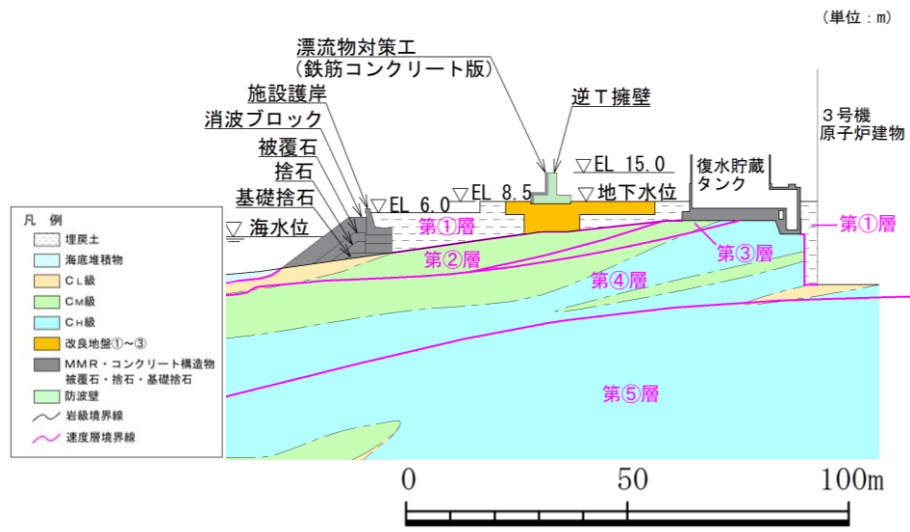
防波壁（逆 T 擁壁）の横断面図（③-③断面）
